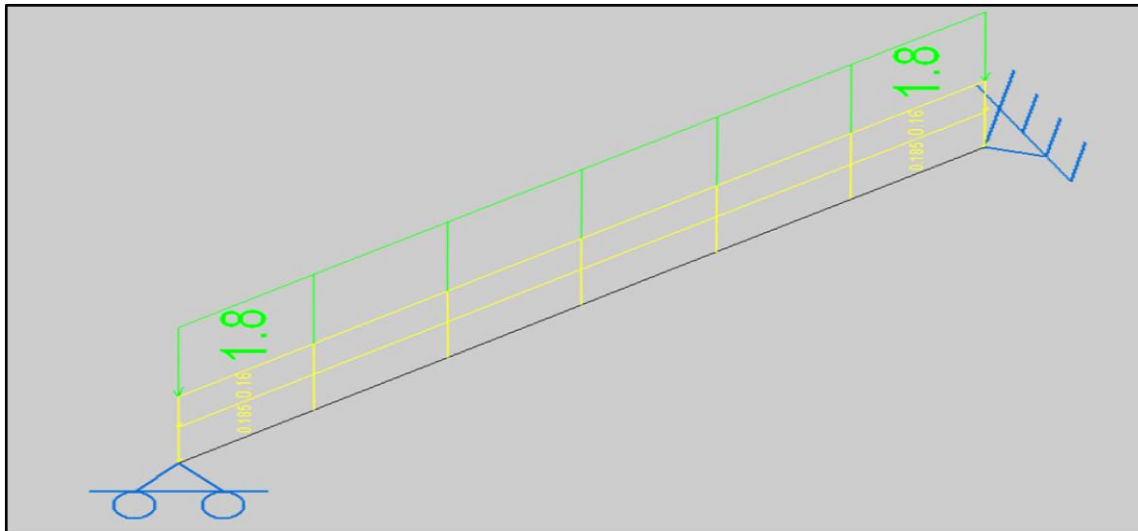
Cargas aplicadas sobre la viga A en Metal 3D
